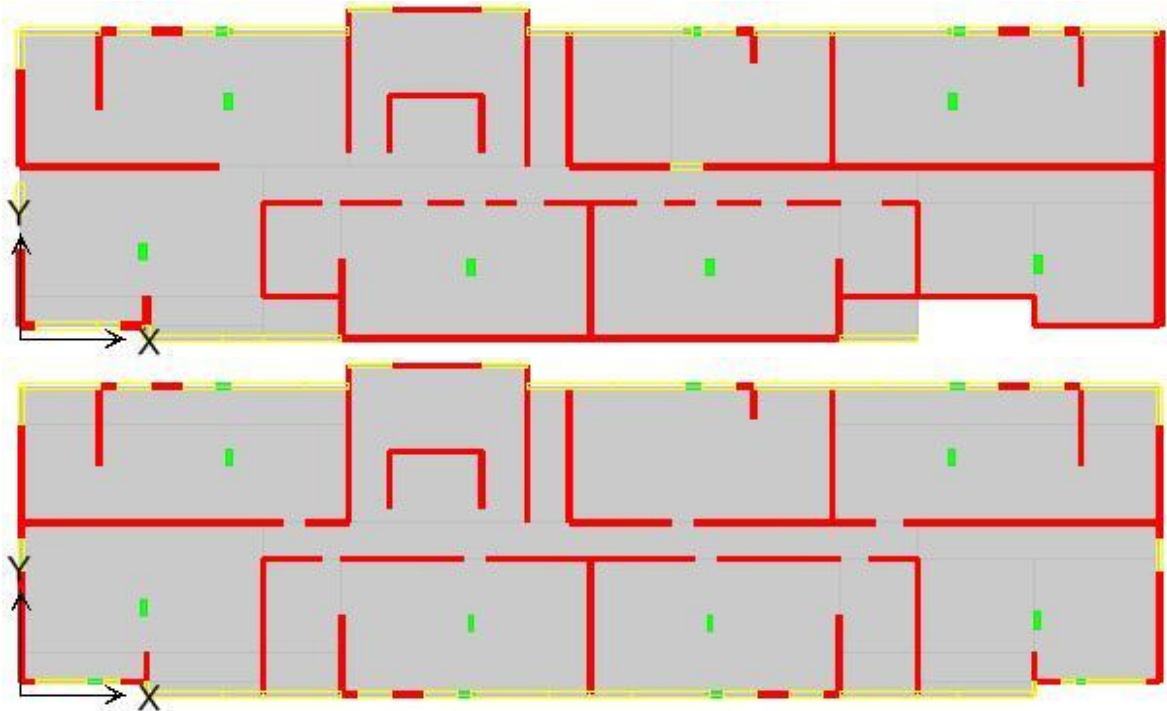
Planta primer piso (arriba) y piso tipo (abajo) edificio H7
